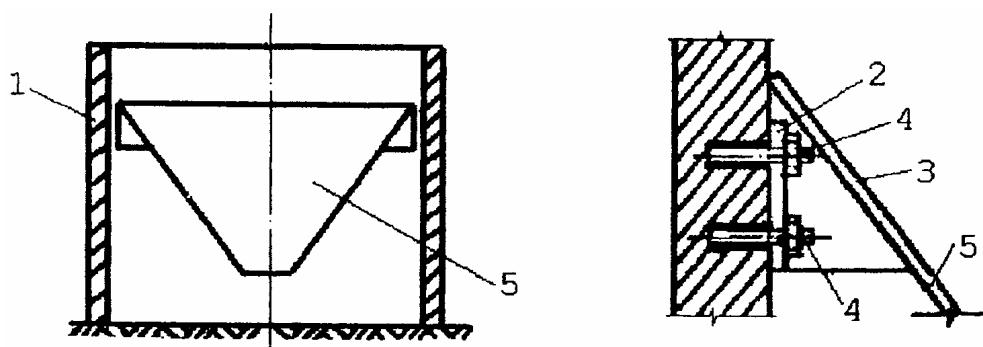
Крепление закладных элементов к стенам силосных сооружений с помощью клеевых анкеров периодического профиля: 1 – железобетонная стена сооружения; 2 – клеевой шов; 3 – закладной элемент крепления; 4 – анкер периодического профиля; 5 – стальная воронка
